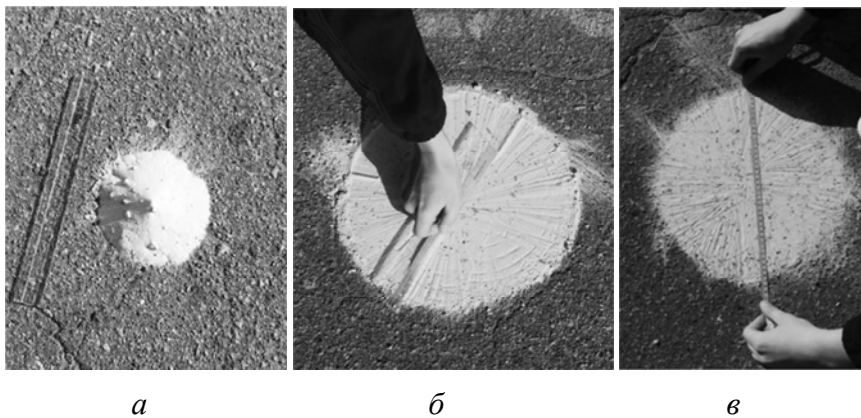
Стадии подготовки и измерения шероховатости дорожного покрытия
